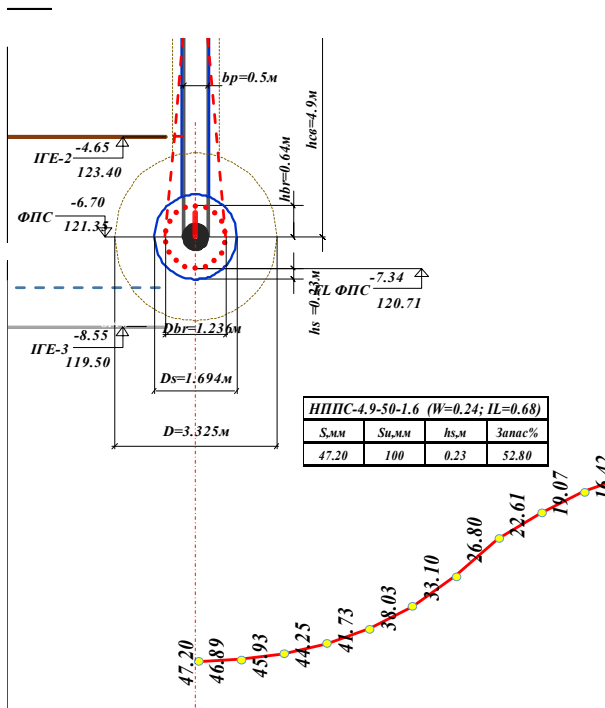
Осідання фундаменту з НППС-4.9-50-1.6 під колони вздовж осей Г при вологості ґрунту W=0.124 складає 47.2 мм.
